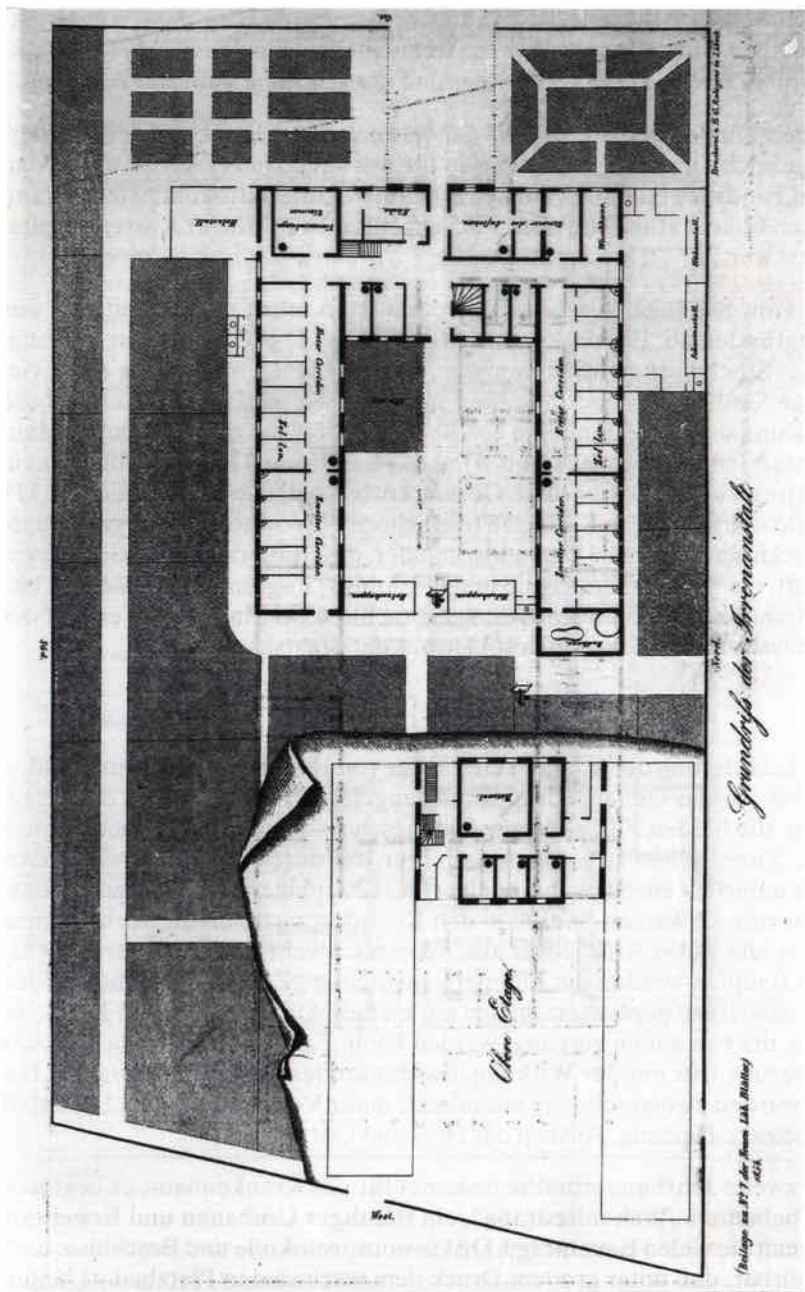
Grundriß der „Irrenanstalt“. 1854.
